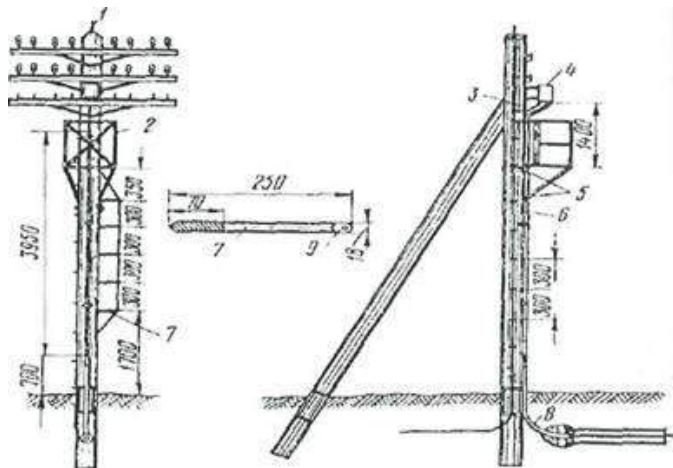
Крепление верхней части железобетонной опоры.
